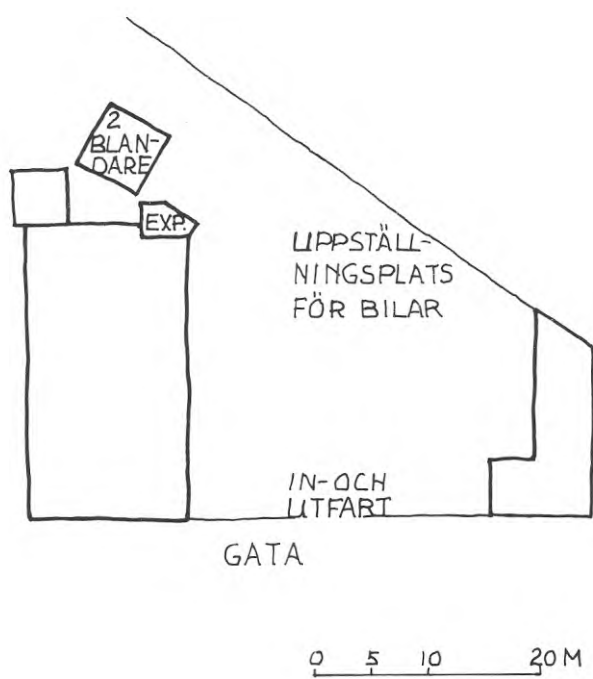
Planskiss över fabrik B. Skala 1:400.
